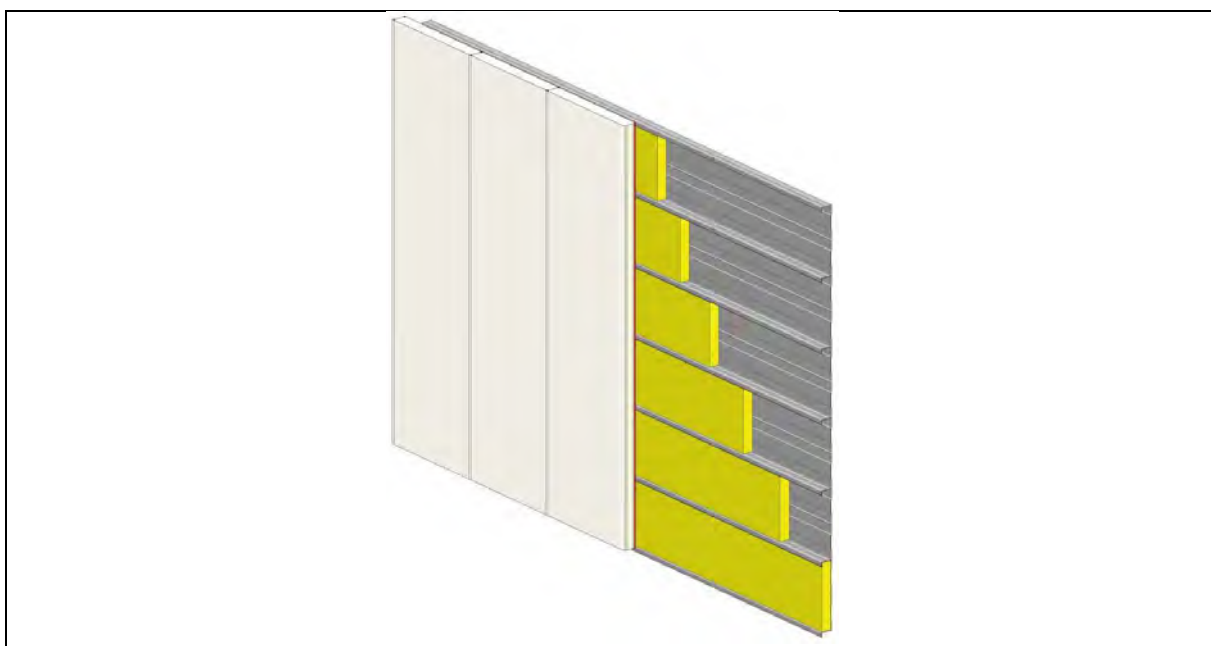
„Hybridsanierung“ einer Kassettenprofilfassade mit vertikal verlegten Sandwichelementen
